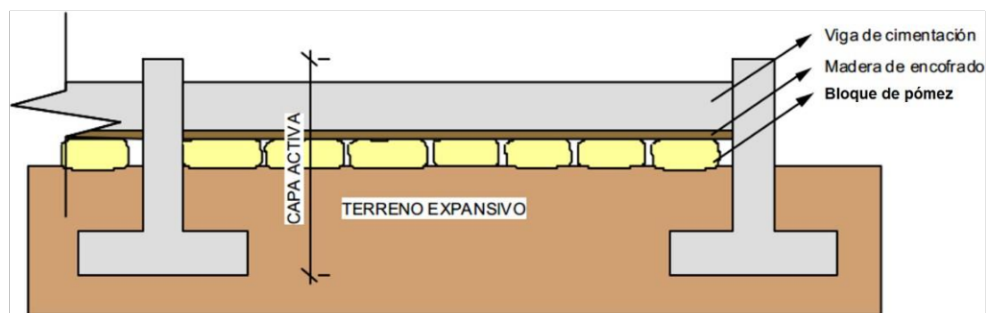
Cimiento de zapatas con vigas apoyadas en bloques de pómez. Fuente: (Vélez Dávila, P. E. 2012).
